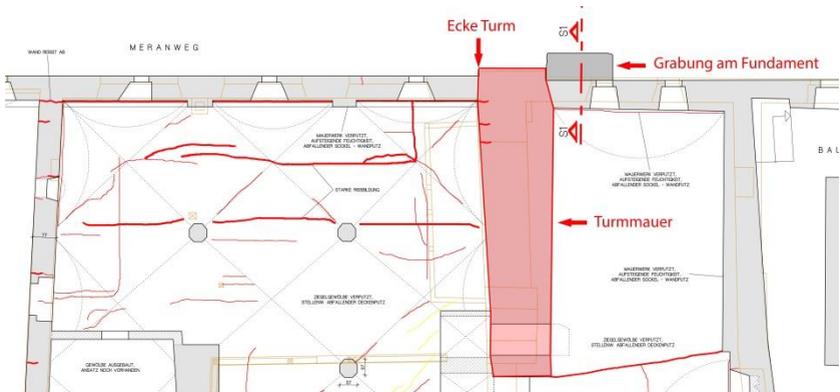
Grundrissdetail des Erdgeschosses im Bereich des ehemaligen Torturms
